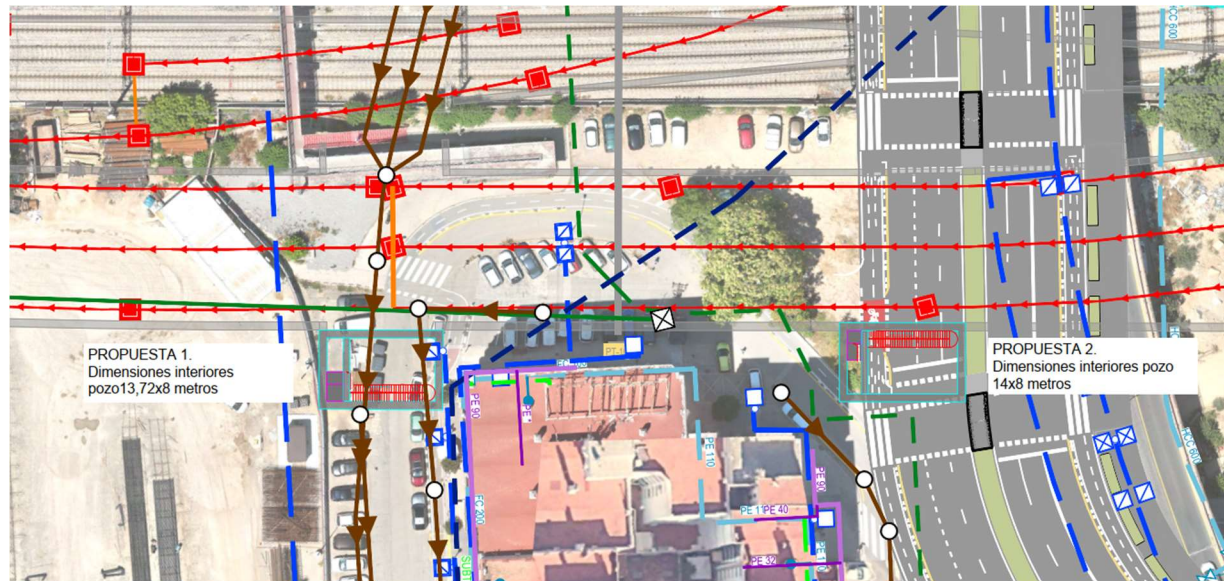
Propuestas para ejecución de nuevo pozo 5 en la rampa 1. Fuente: Planos modificados de la oficina técnica
